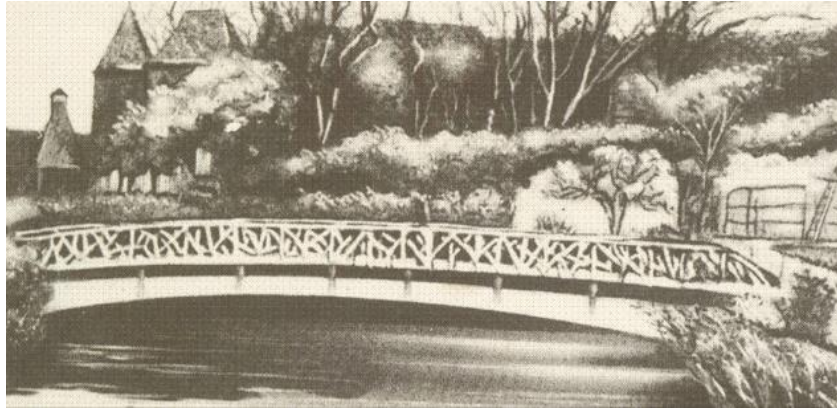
Primeira Ponte em Betão Armado (Monier, 1875).
